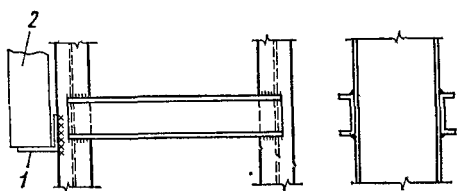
Крепление деталей опирания тяжелых стеновых панелей к подкрановой части ступенчатой колонны крайнего ряда
